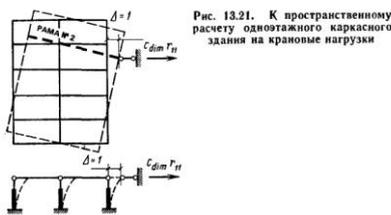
К пространственному расчету одноэтажного каркасного здания на крановые нагрузки
